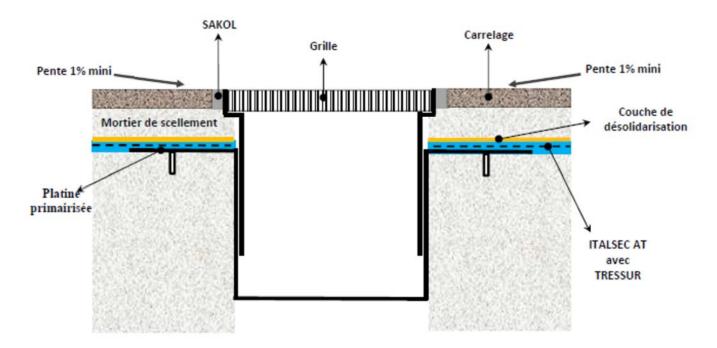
Dispositif de collecte par caniveau en pose scellée
